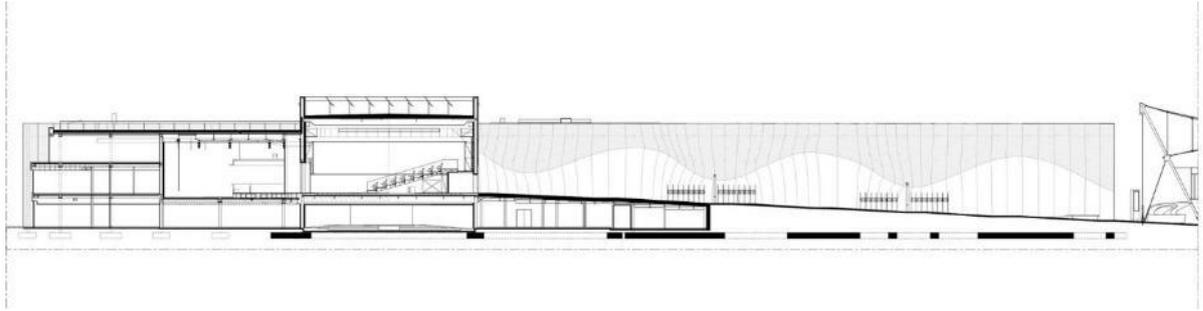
Corte do Pavilhão EAU | EXPO Milão 2015
